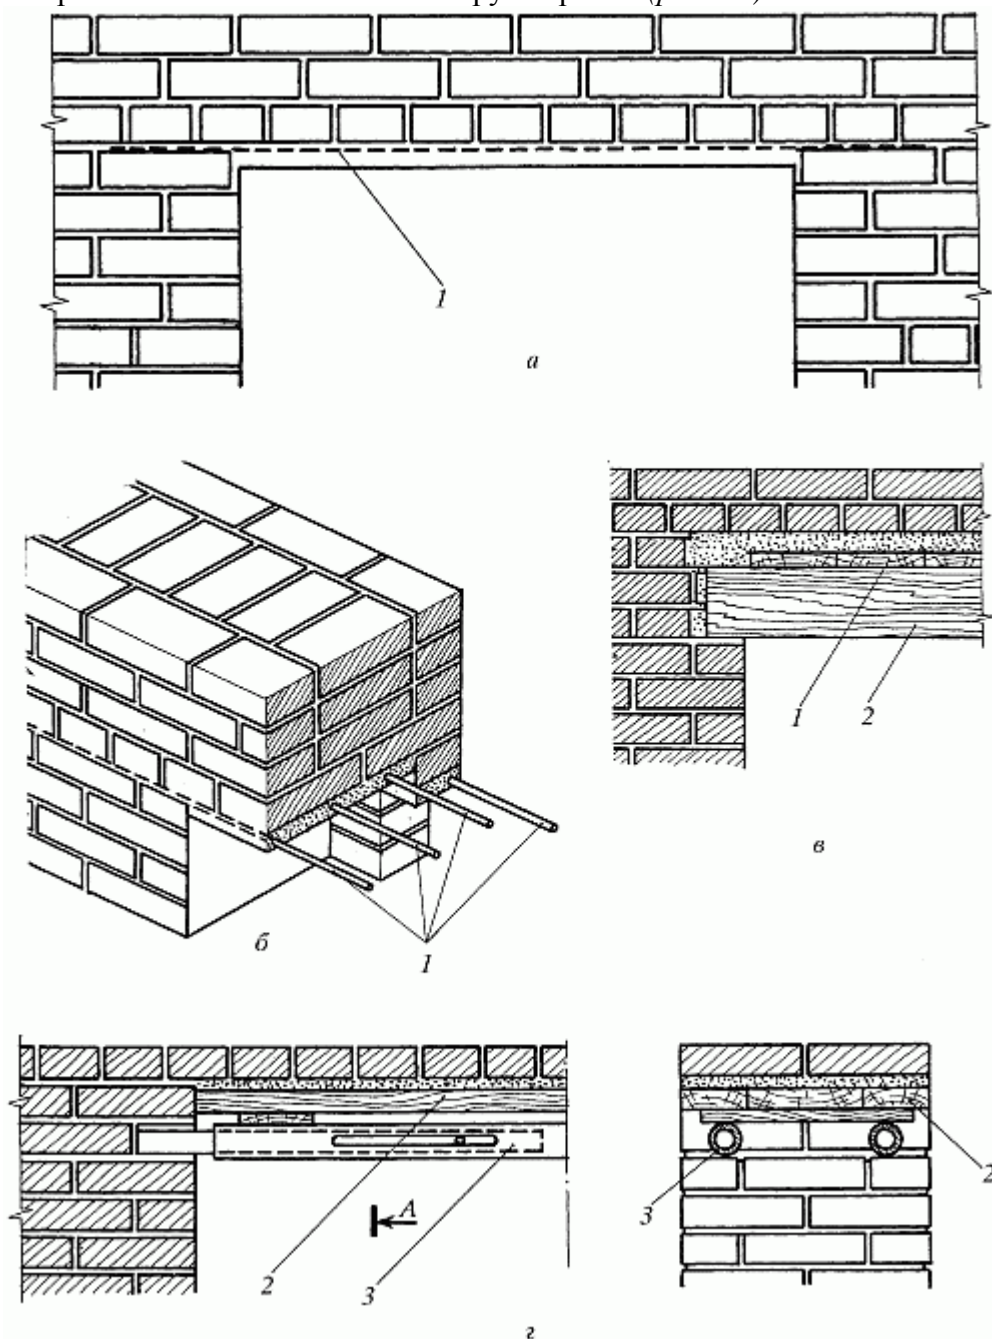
Кладка рядовых перемычек: а – фасад; б – разрез; в – кладка по дощатой опалубке; г – кладка на инвентарных кружалах; 1 – арматурные стержни; 2 – доски; 3 – трубчатые кружала
